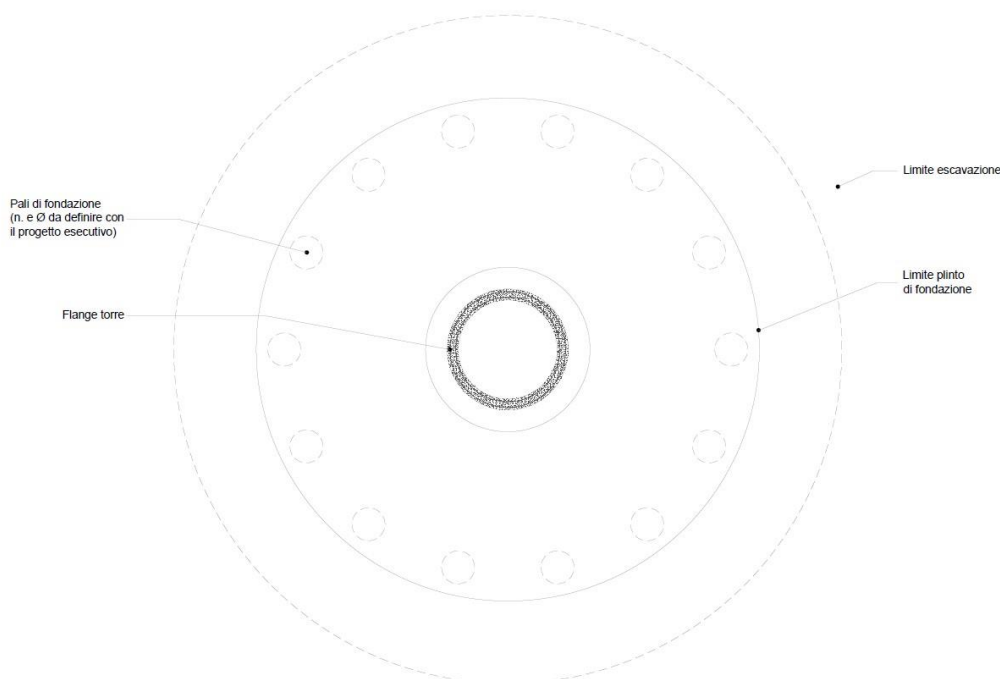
Sezione tipo aerogeneratore - piastra di fondazione su pali
